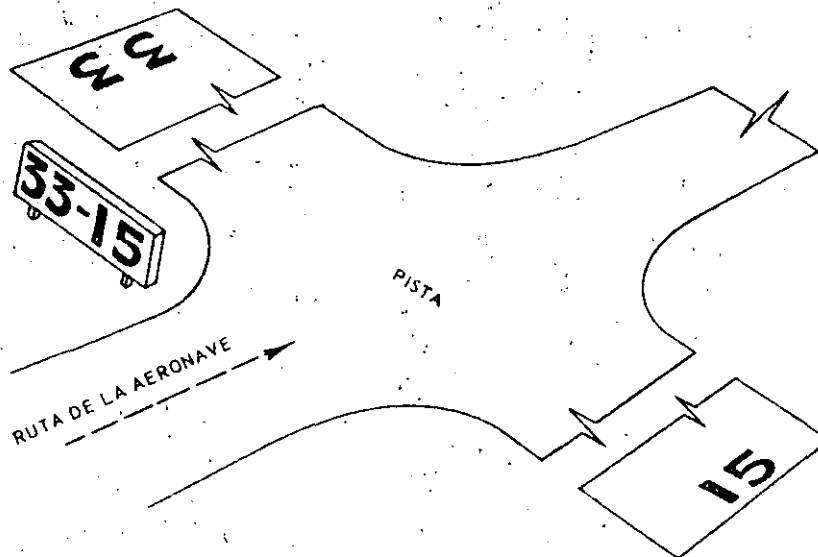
Letrero de intersección, colocado paralelamente a la pista
